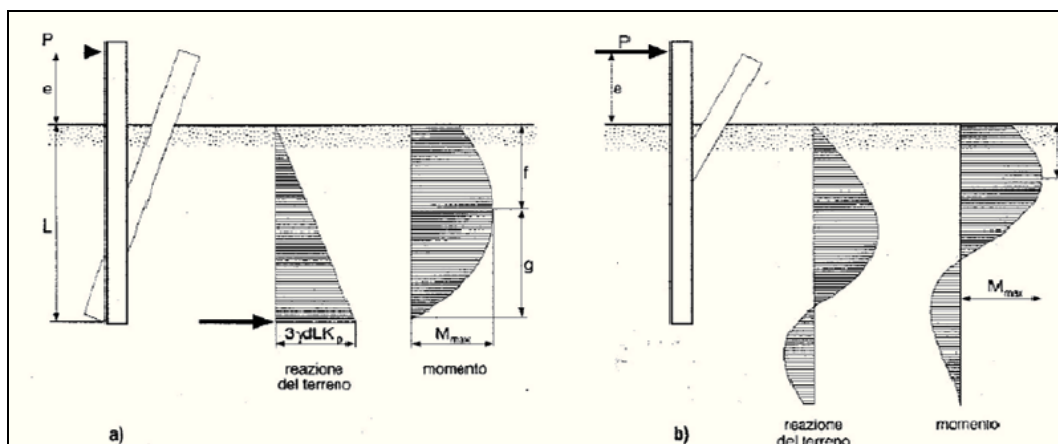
schematizzazione dell'azione del terreno su un palo infisso secondo Broms
